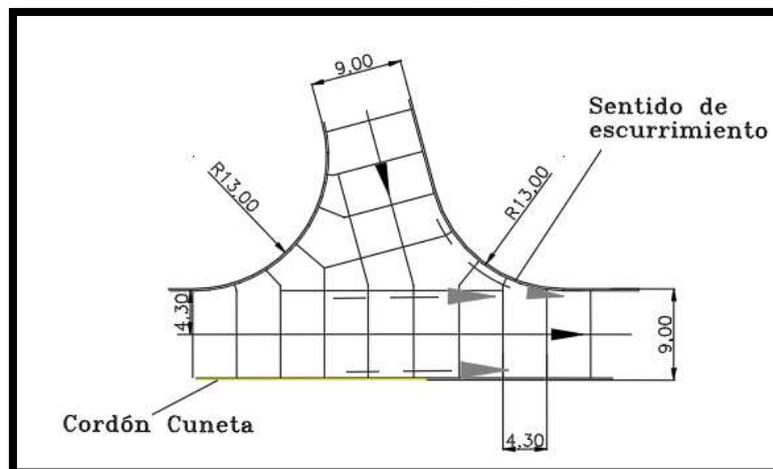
Detalle intersección Calle N°9 y Calle N° 3.
